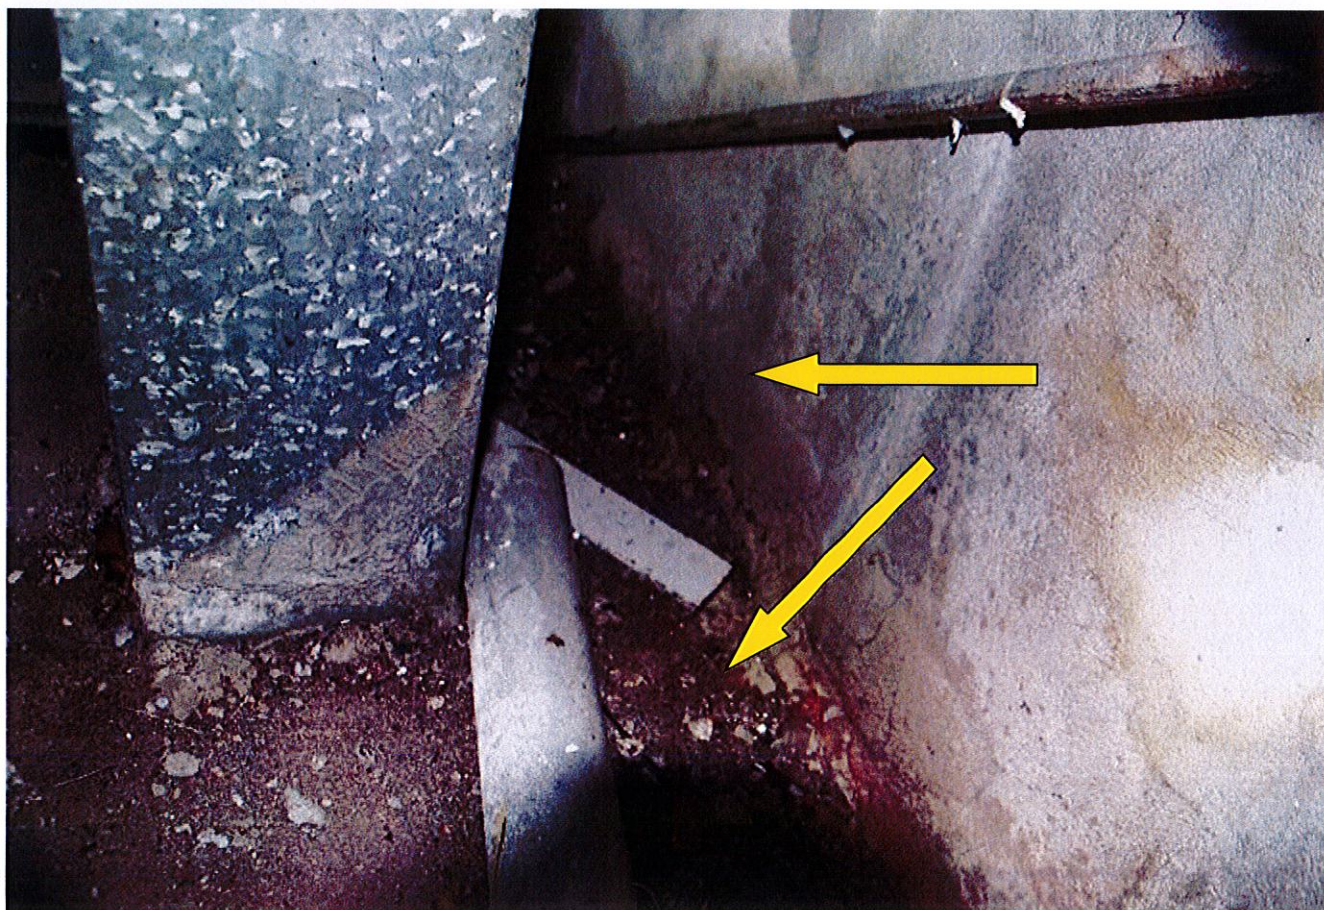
Korozja stali skutkiem przecieków z dachu.
